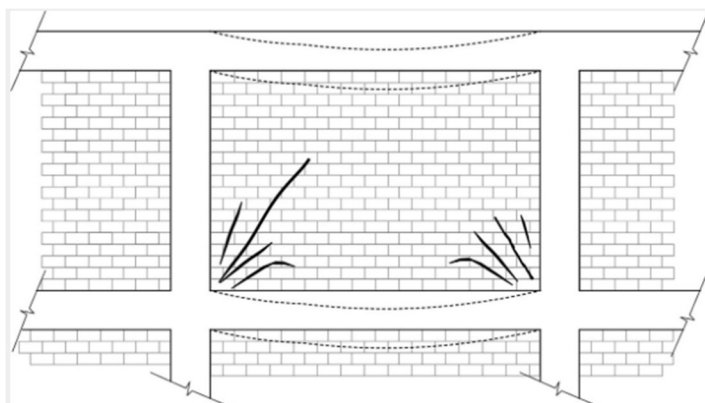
Fissura apresentada em aberturas dos painéis de alvenaria.
